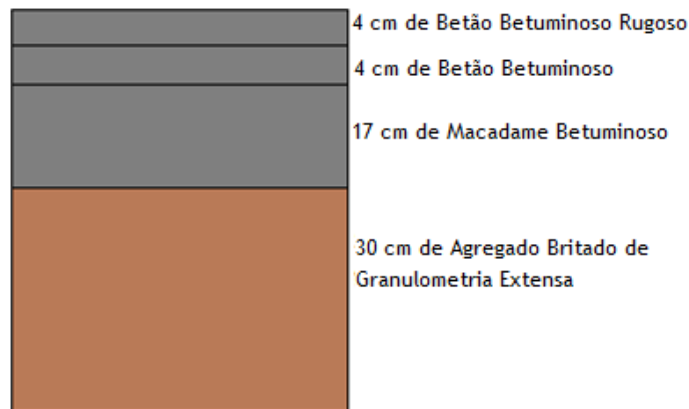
Espessura e composição de cada camada constituinte do pavimento (CE2)
